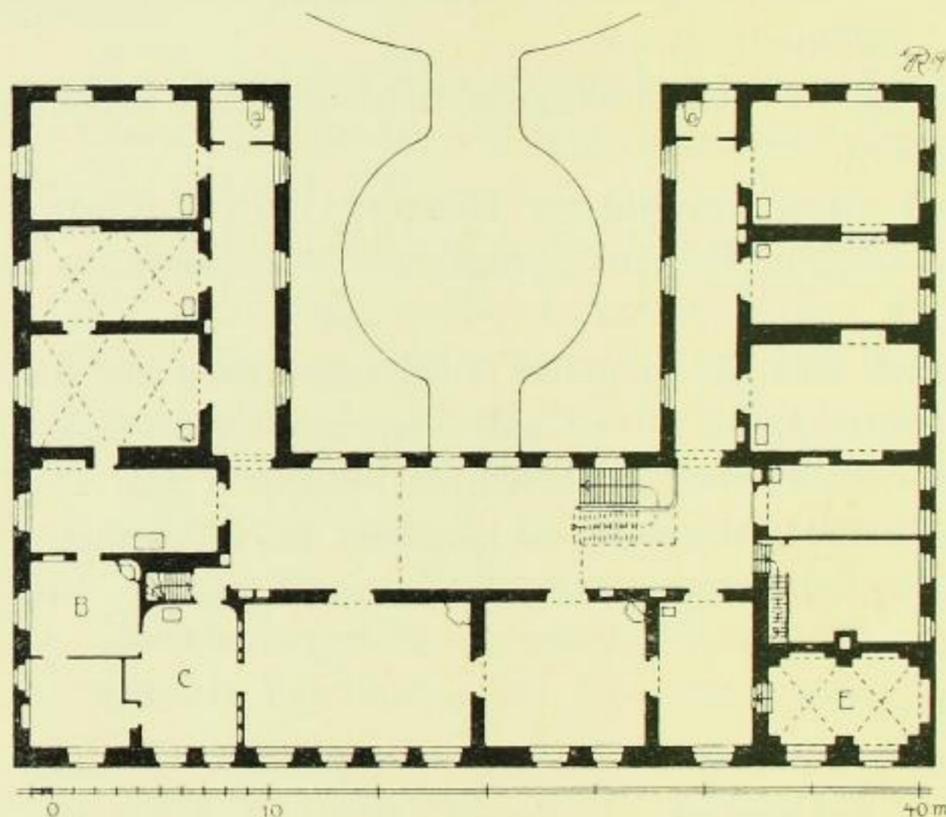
Glossen, Schloß, Grundriß des Obergeschosses.
